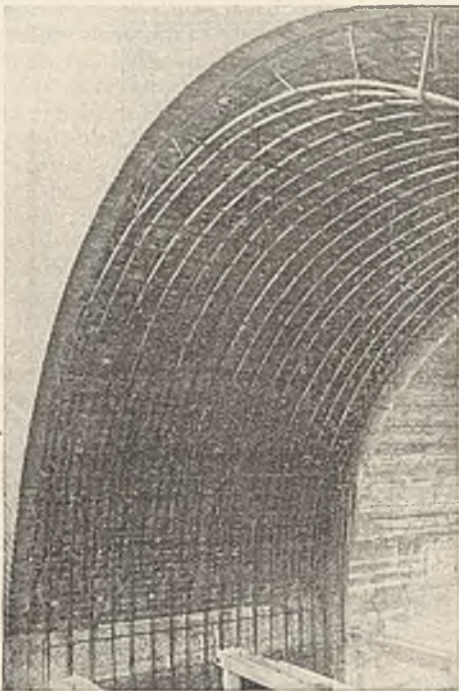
Viadukt Klähäm. Bewehrung des Traggewölbes u. fertigbetonierte erste Gewölbehälfte.
